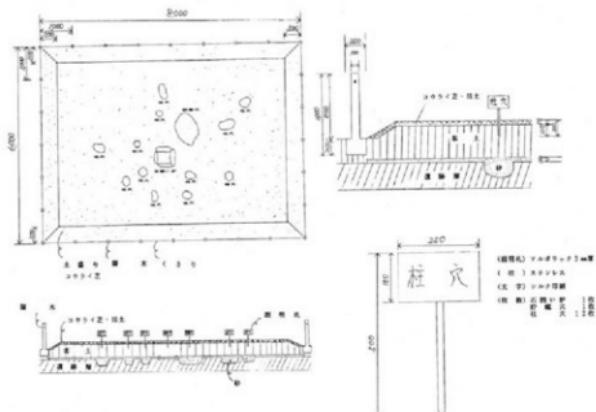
遺構保存整備工事 平面図・断面図・詳細図
